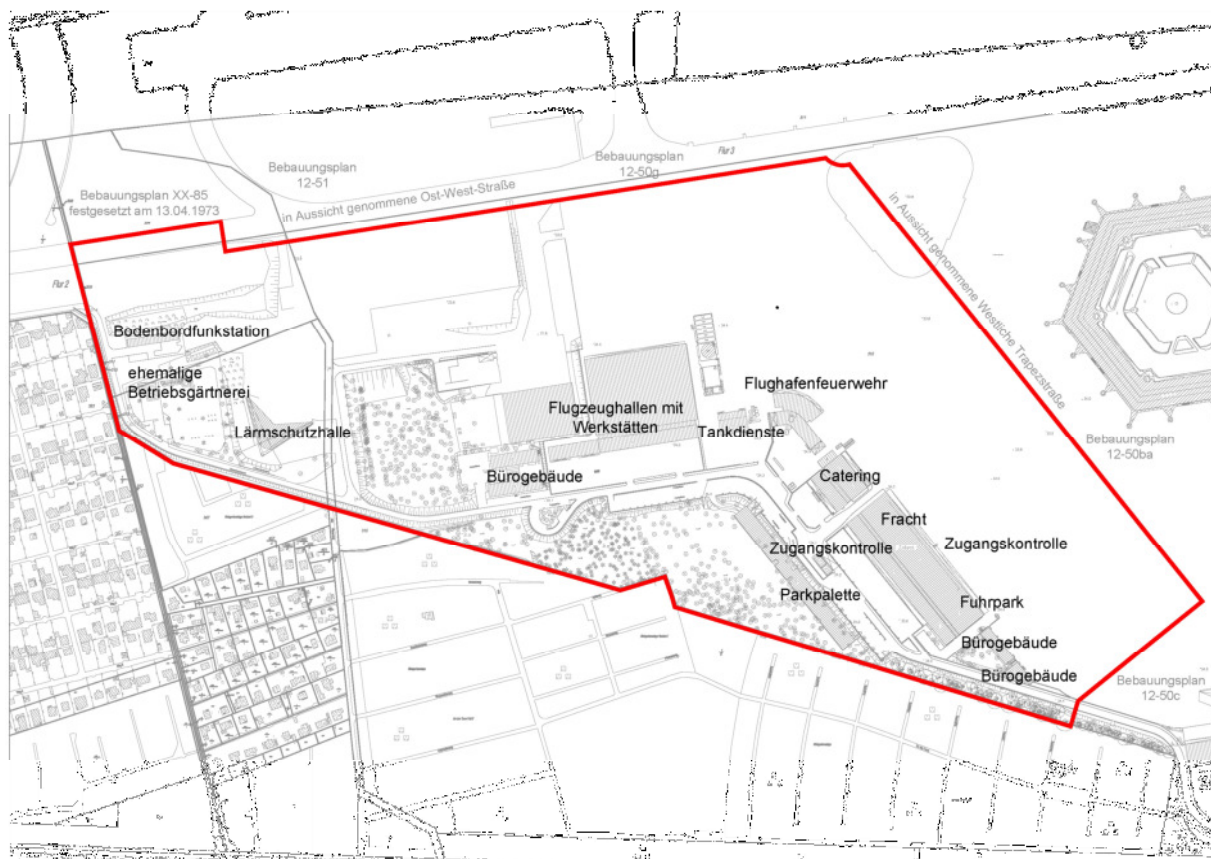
Bestandsgebäude mit Abgrenzung des Bebauungsplans 12-50a
